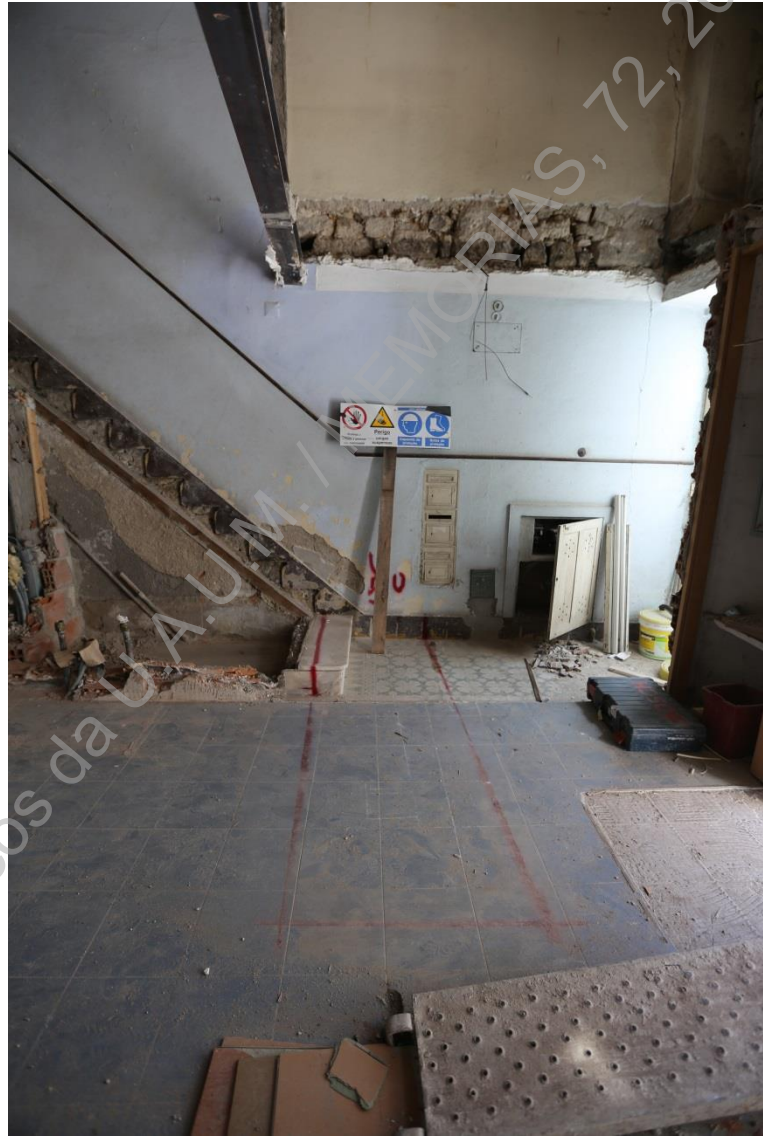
(IMG_1621) – Marcação da sapata 4 (N/S).
